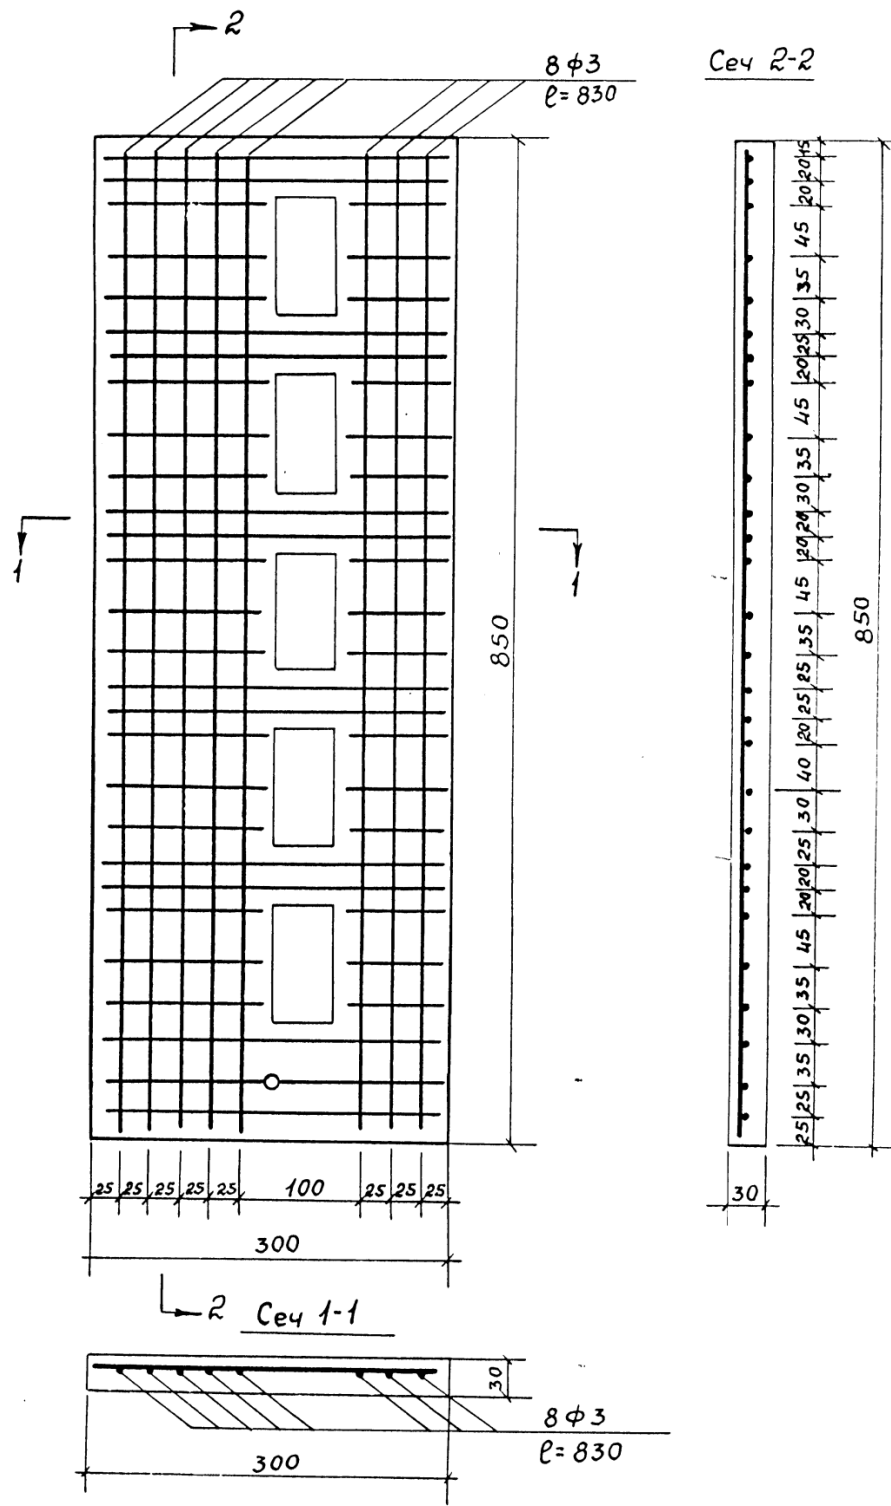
Схема армирования диафрагмы-модели пятиэтажного здания в масштабе 1:20
